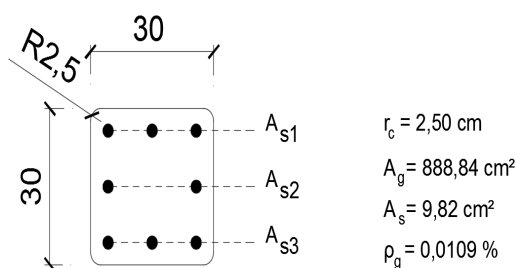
Camadas de armaduras e propriedades da seção transversal (dimensões em cm).
